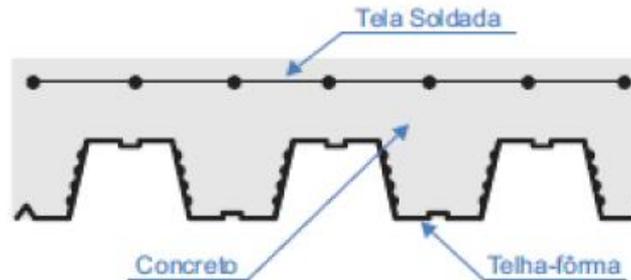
Esquema de aplicação da tela de fissuração
